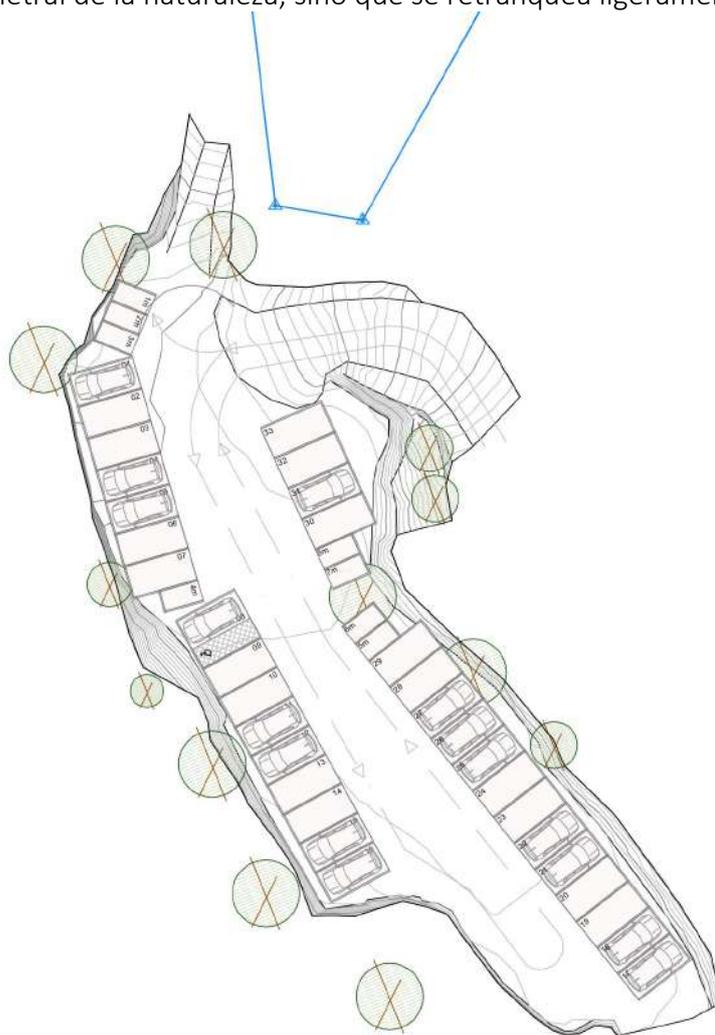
Plano de la alternativa 1 de aparcamiento ordenado.
